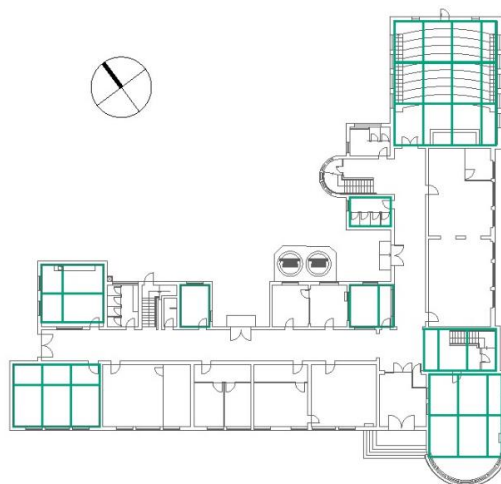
Planta baixa do 1º pavimento da escola Assis Brasil, indicando a modulação dos ambientes.
